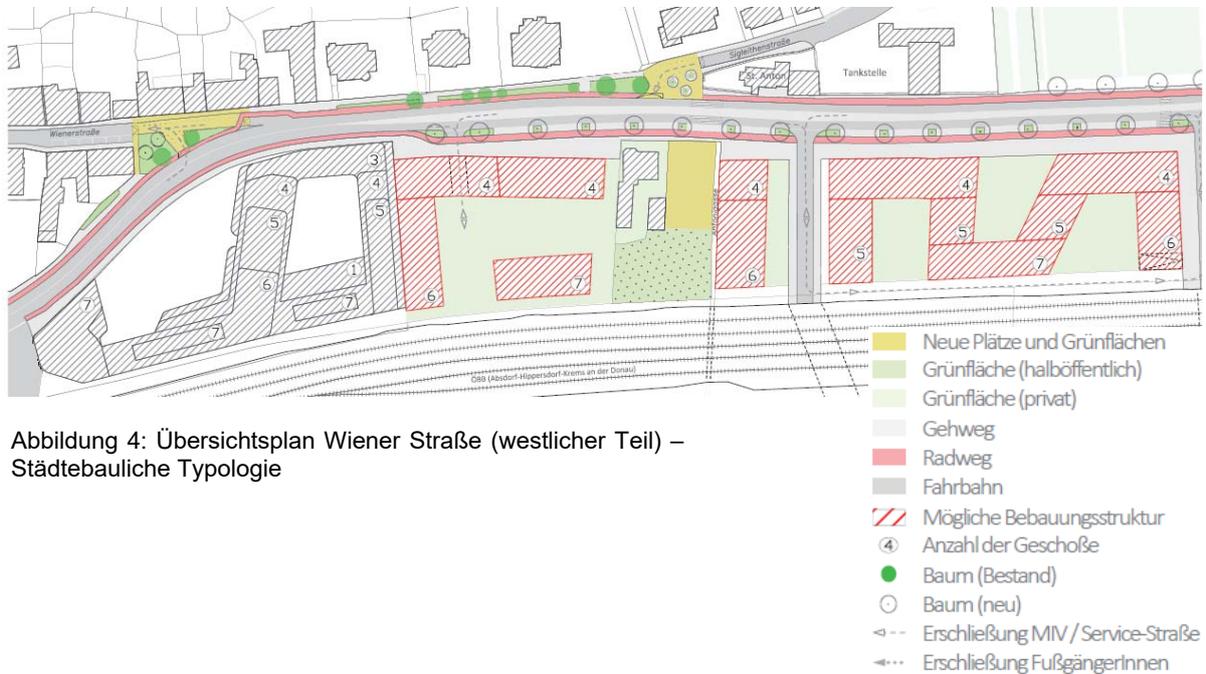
Übersichtsplan Wiener Straße (westlicher Teil) – Städtebauliche Typologie
